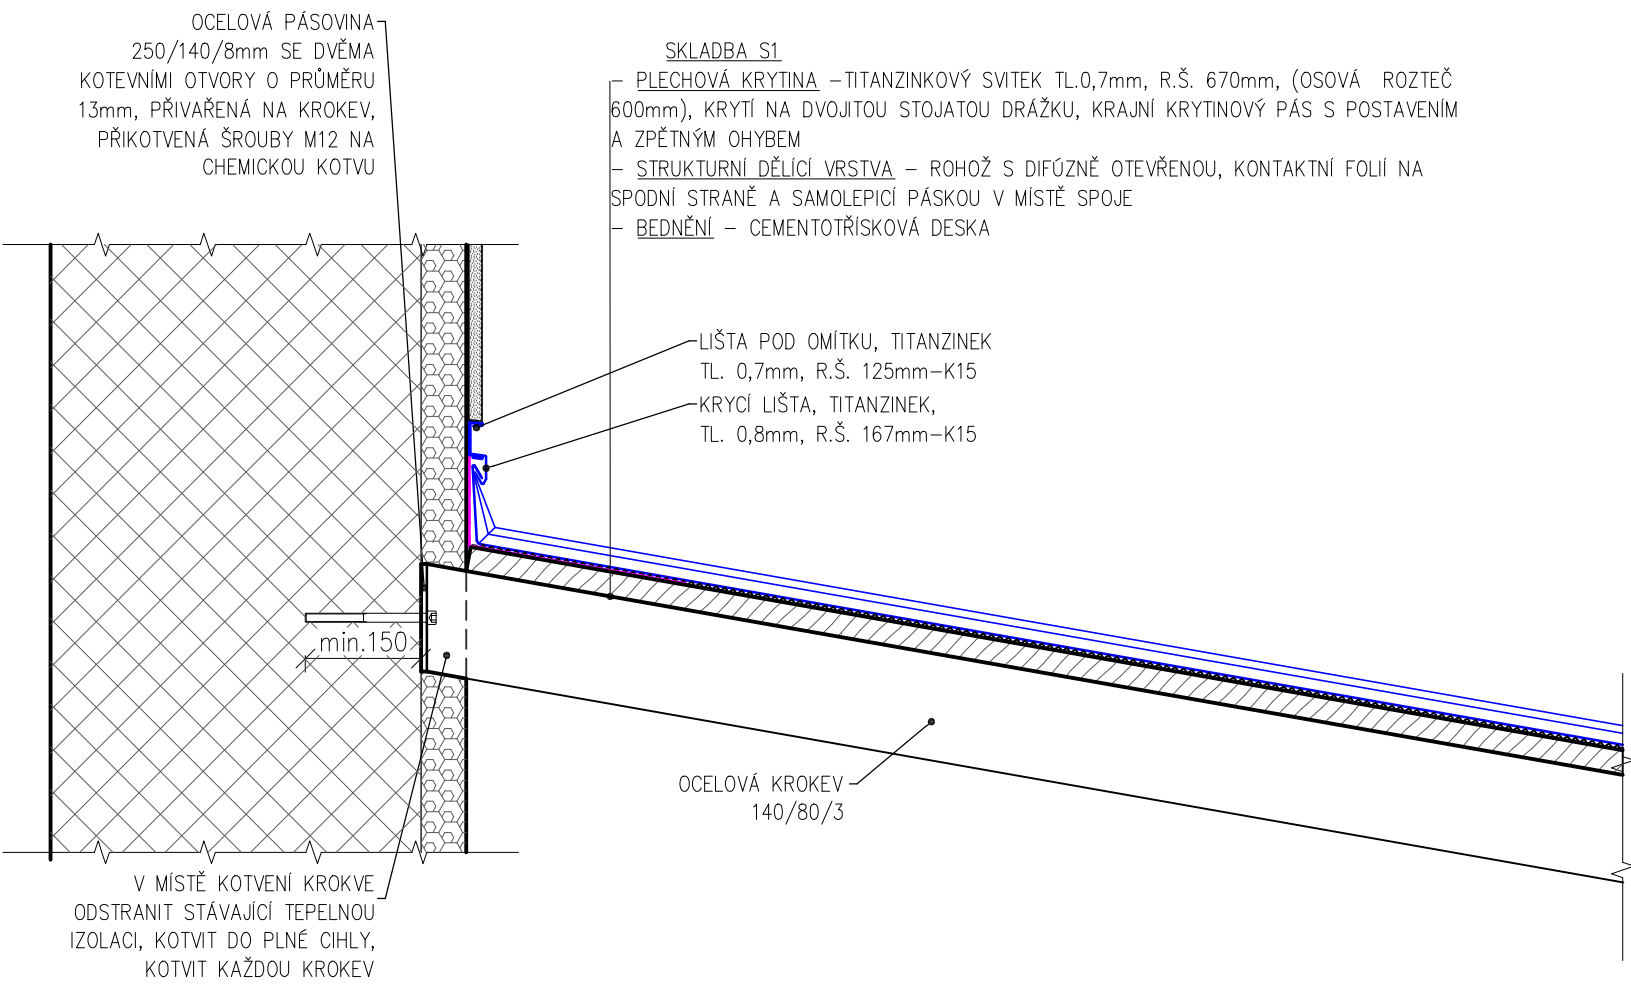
DETAIL C - LEMOVÁNÍ ČELNÍ , M 1:10
